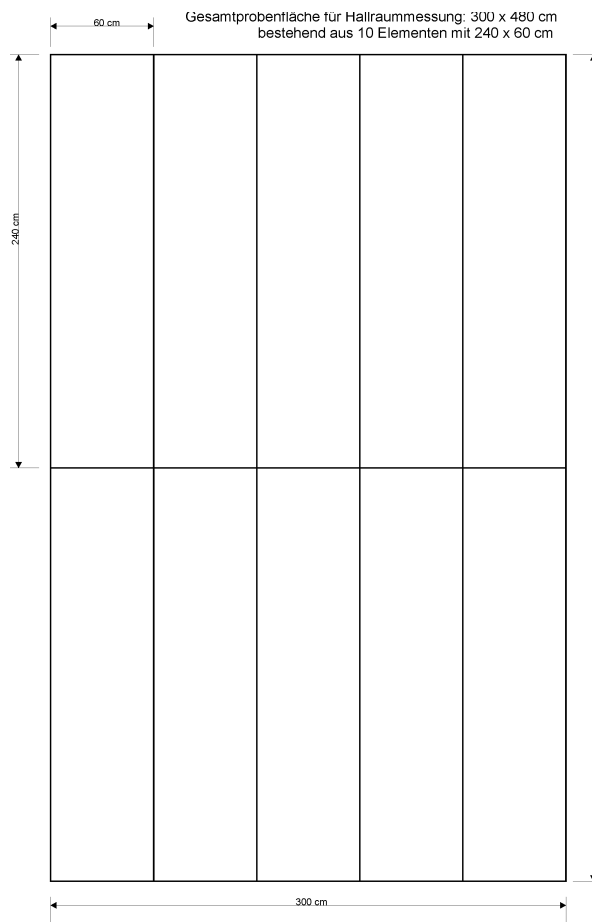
Gesamtprobengröße für Hallraummessung 480 x 300 cm für die Proben I bis V
